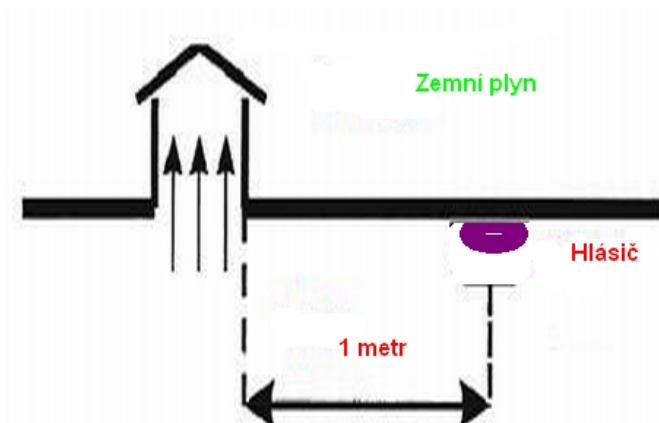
příklad umístění detektoru v proudění vzduchu
